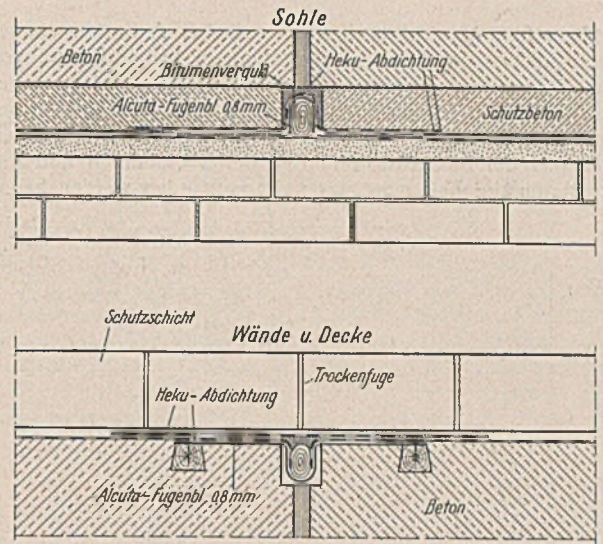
Anordnung der Fugendichtung in Sohle, Wänden und Decke des Unterführungsbauwerks Zeppelinstraße—Große Straße in Nürnberg mit Alcuta-Dehnblechen.
